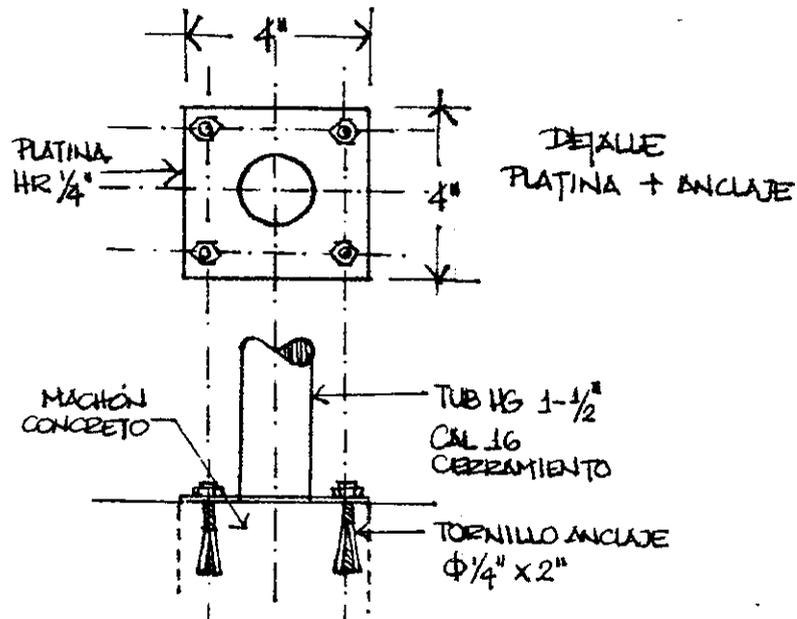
Detalle del empalme del paral y el anclaje con tornillería con encamisado expansible.
